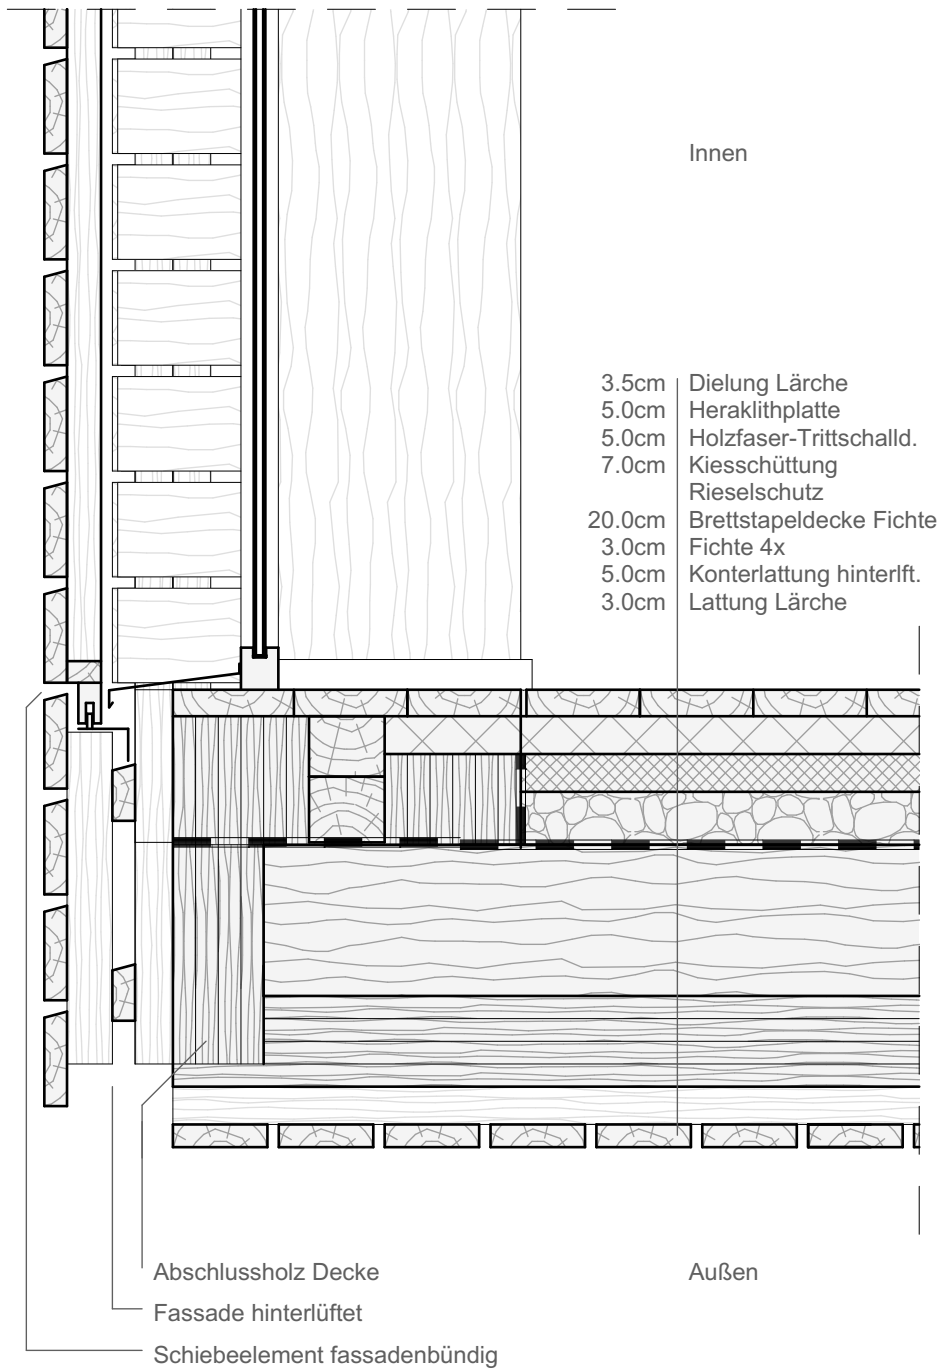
Balkon - Detail 1 M 1:10
